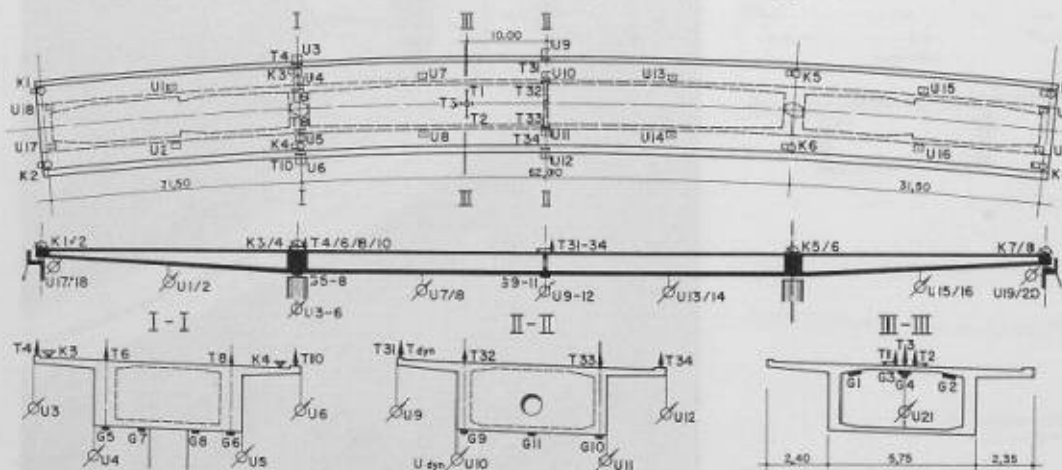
Messschnitte mit Anordnung der Messinstrumente. Grundriss, Längsschnitt und Querschnitte
